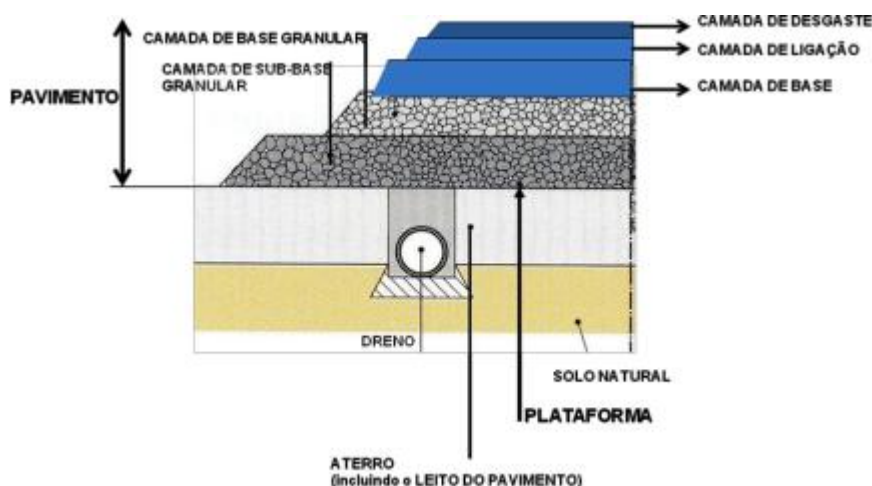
Diagrama esquemático da estrutura de um pavimento rodoviário (InIR, 2012)
